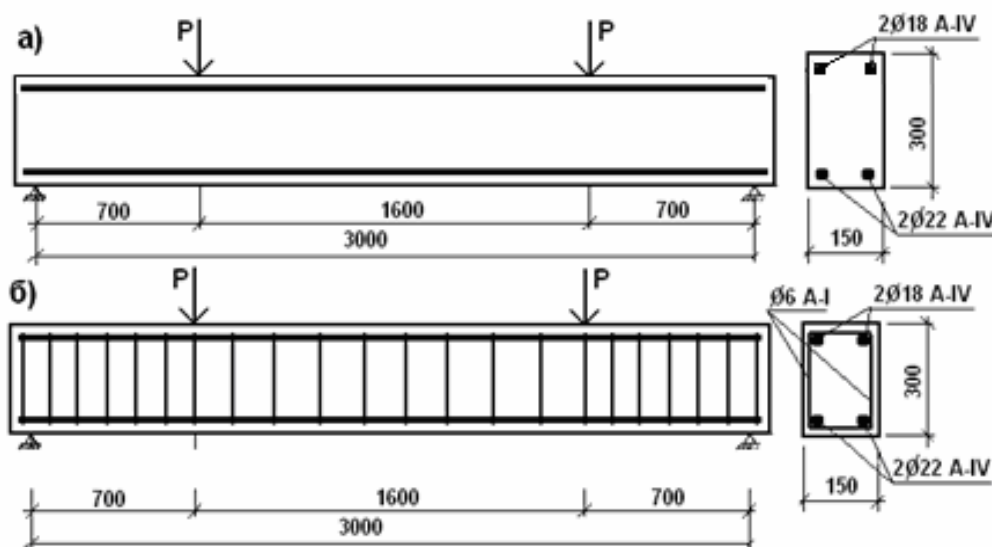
Конструкция железобетонных балок прямоугольного сечения:
